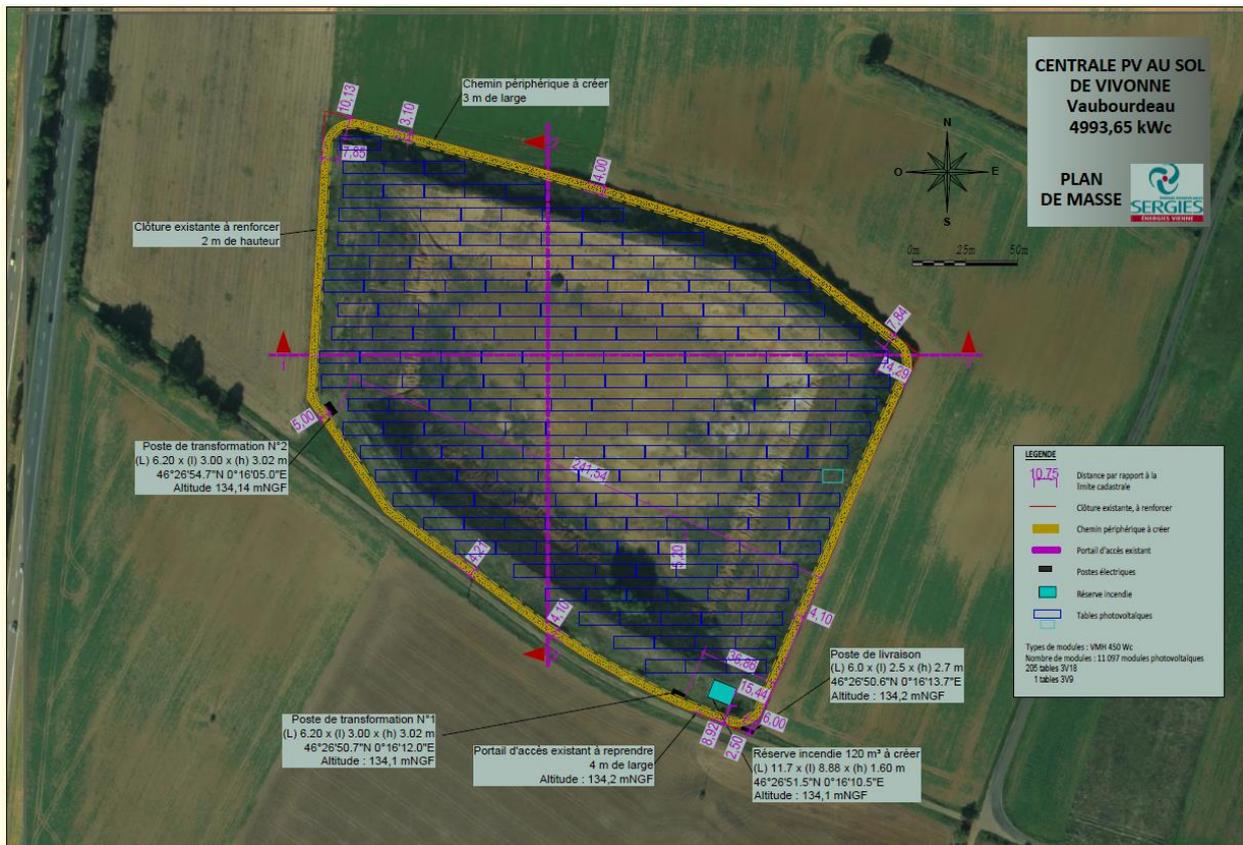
Plan d'implantation de la centrale photovoltaïque
